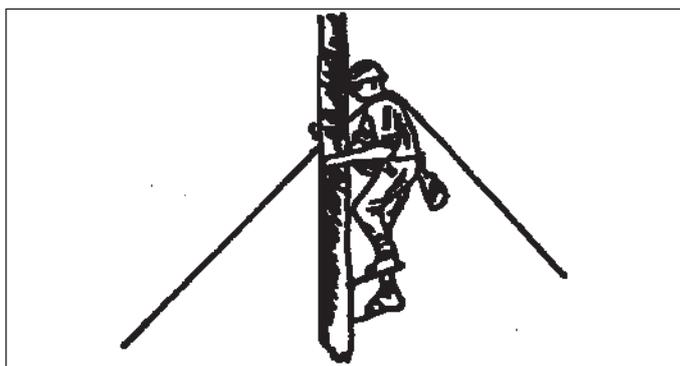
Поднятие провода и монтажного ролика на опору.
